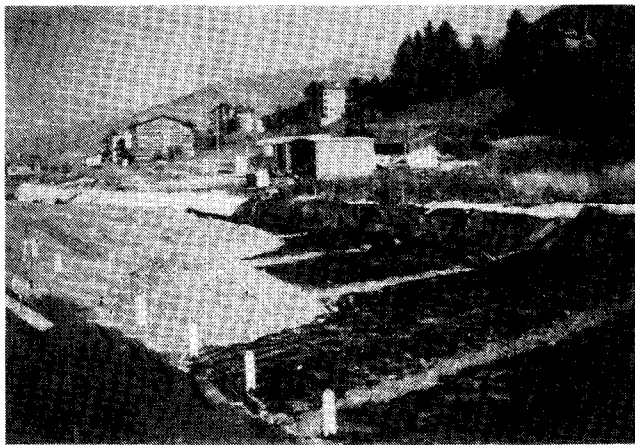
Straßenbau (Straßenunterbau Haute Nendaz, CH)
